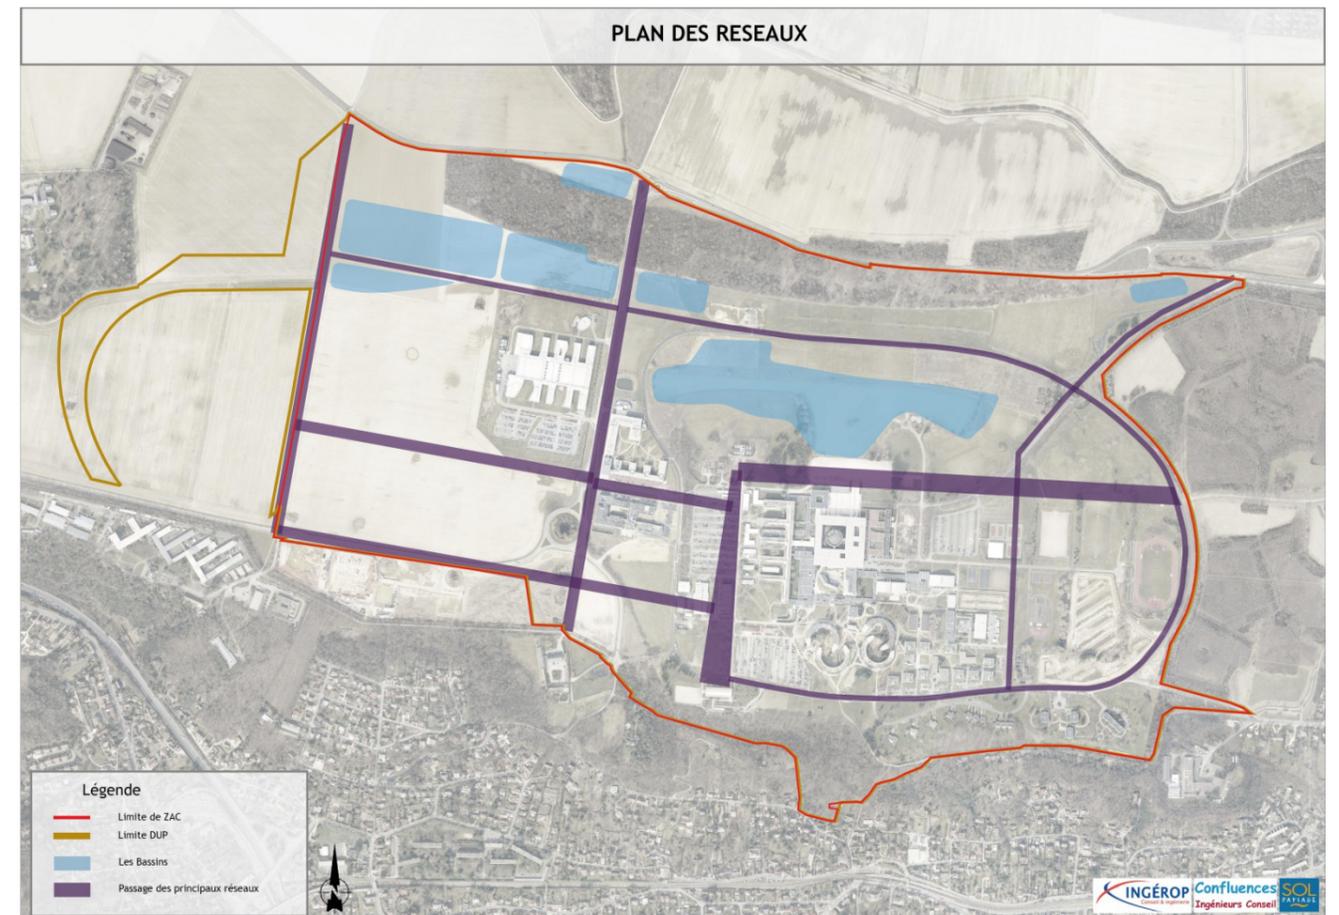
Plan des boulevards supports du passage des principaux réseaux
